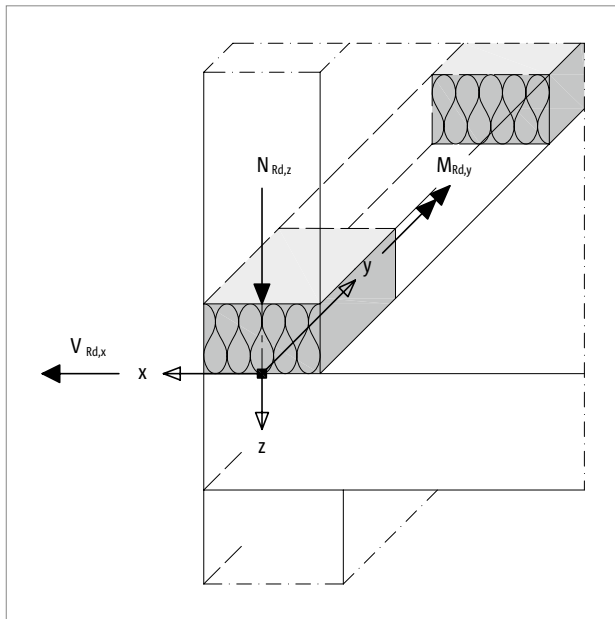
Schöck Isokorb® T tipo AP: regola dei segni per il calcolo di parapetti sovrapposti
